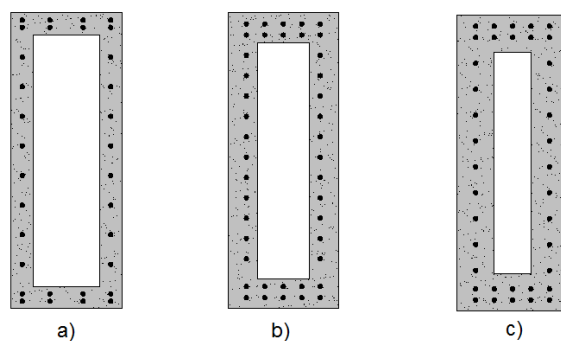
e Secciones de las pilas analizadas a) Pila chica 32 var #12
